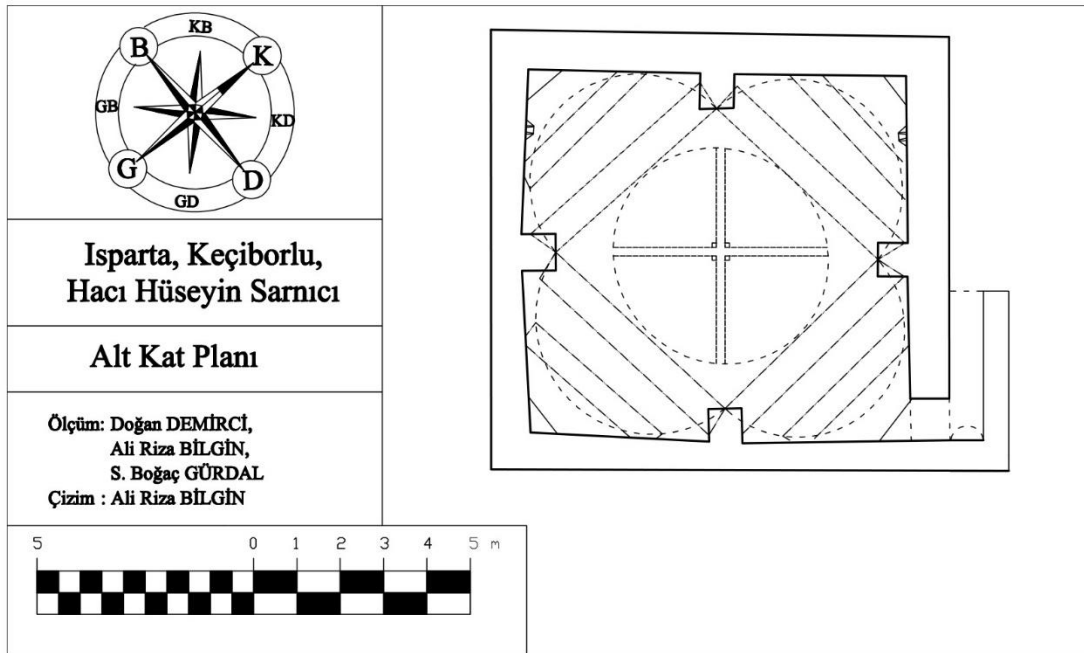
Hacı Hüseyin Sarmıcı, Alt Kat Plan.
